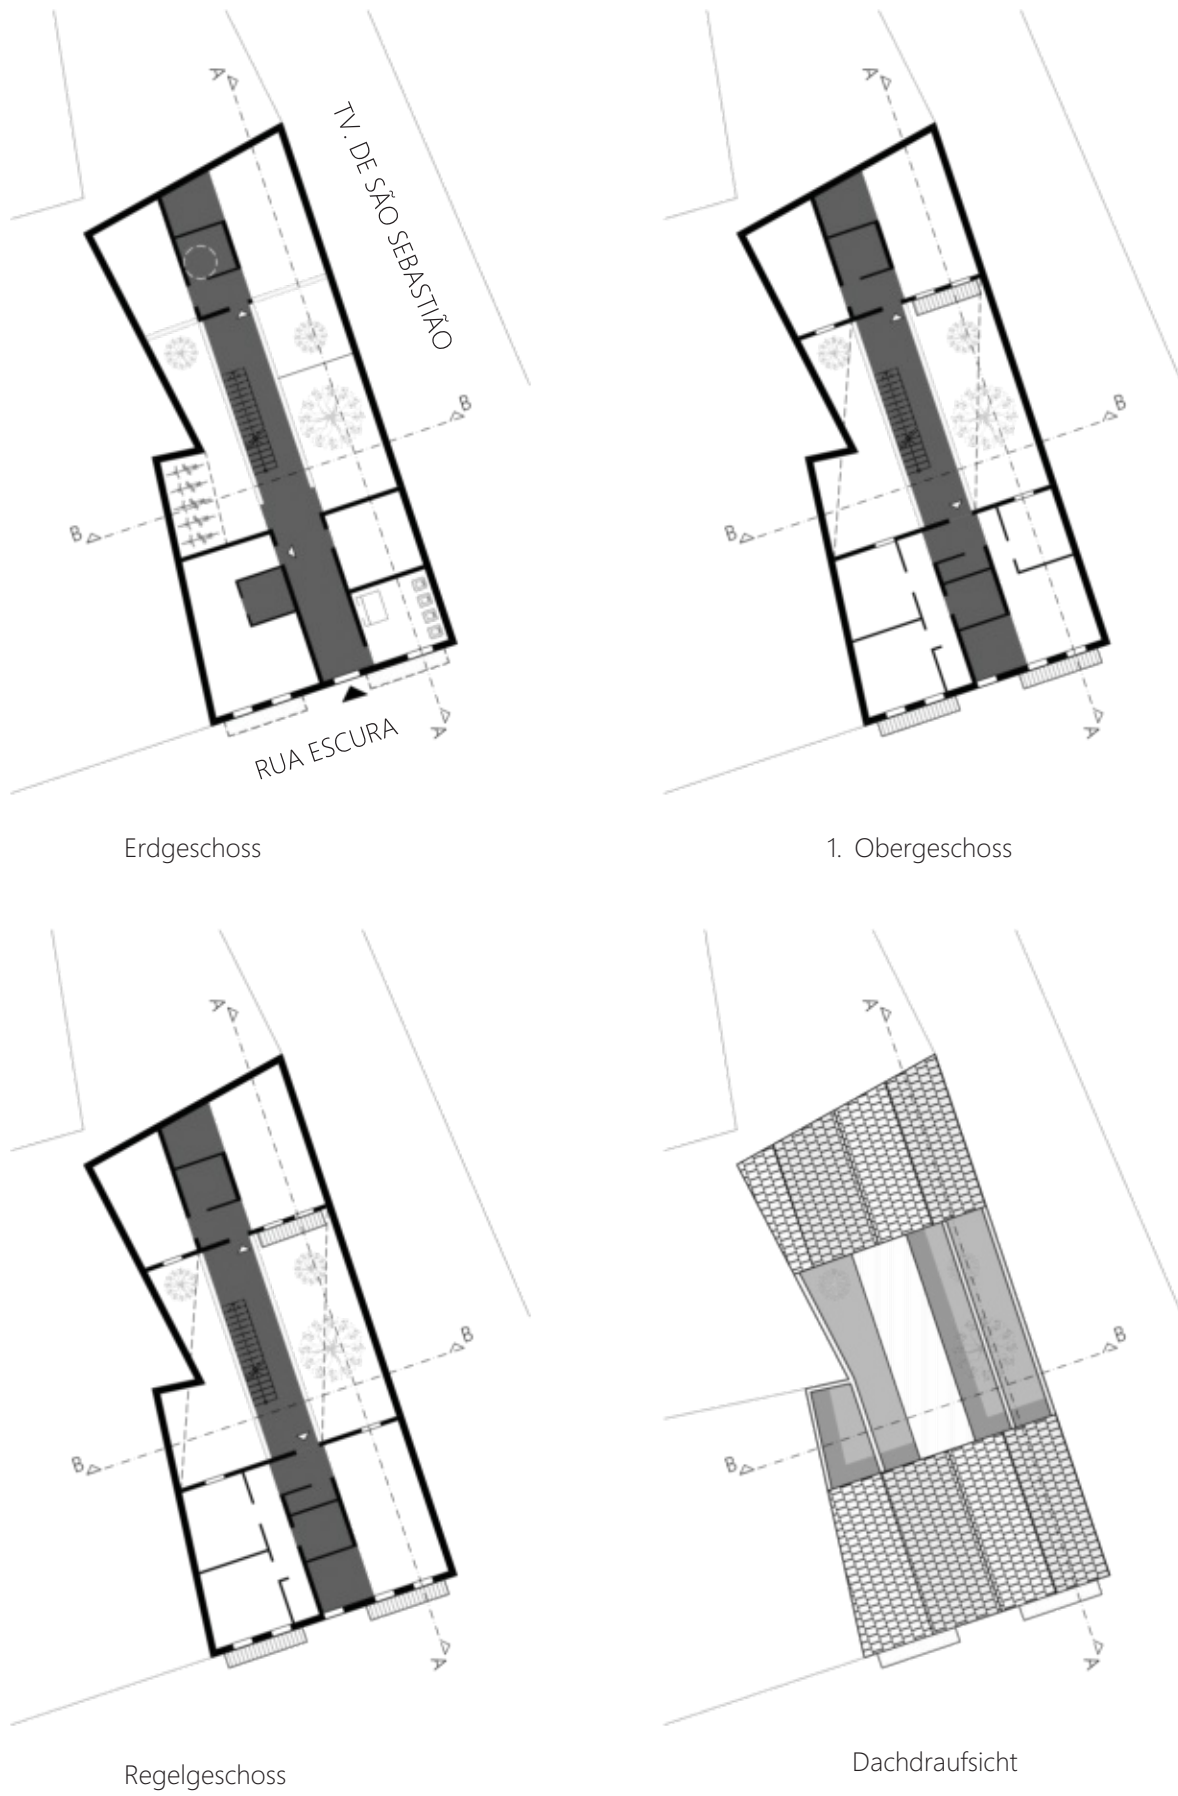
Grundrisse (Vergessene Orte)
